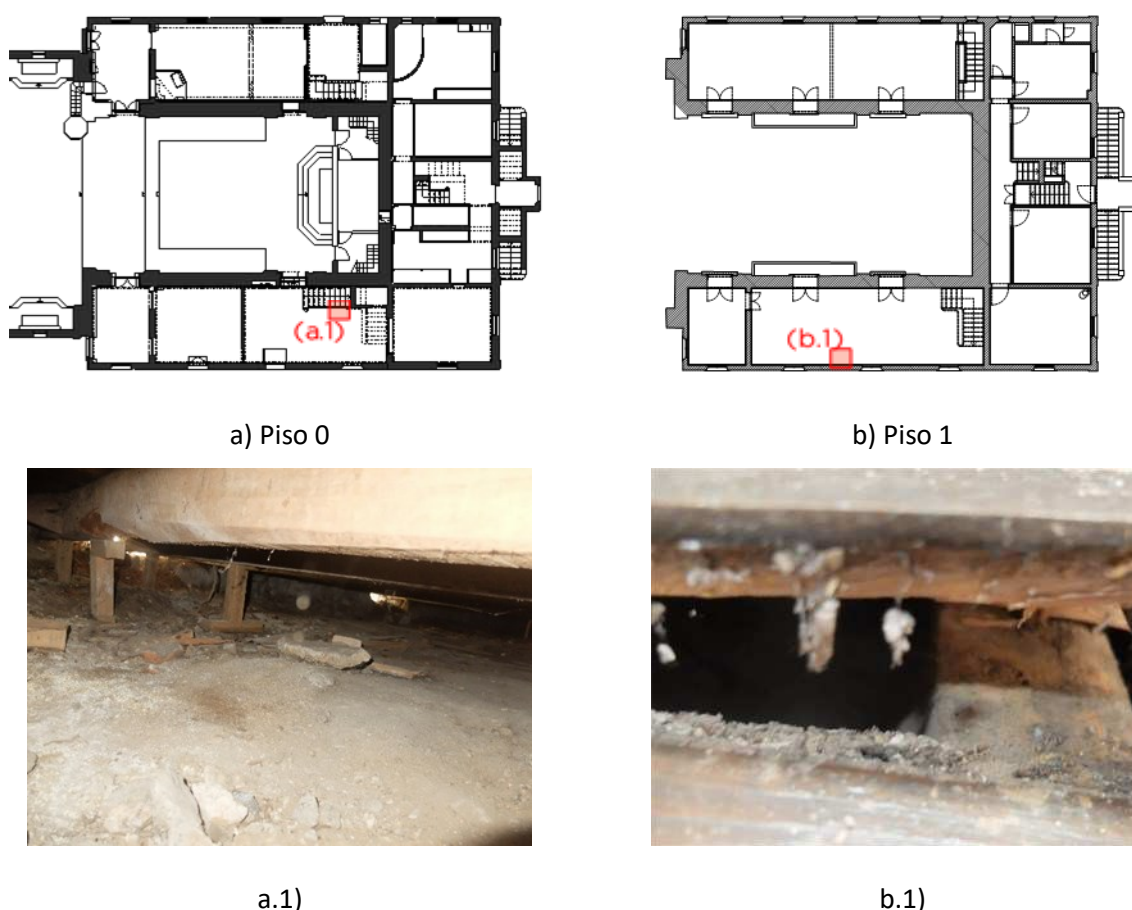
Localização das janelas de sondagem em aberturas já existentes nos pavimentos de madeira
